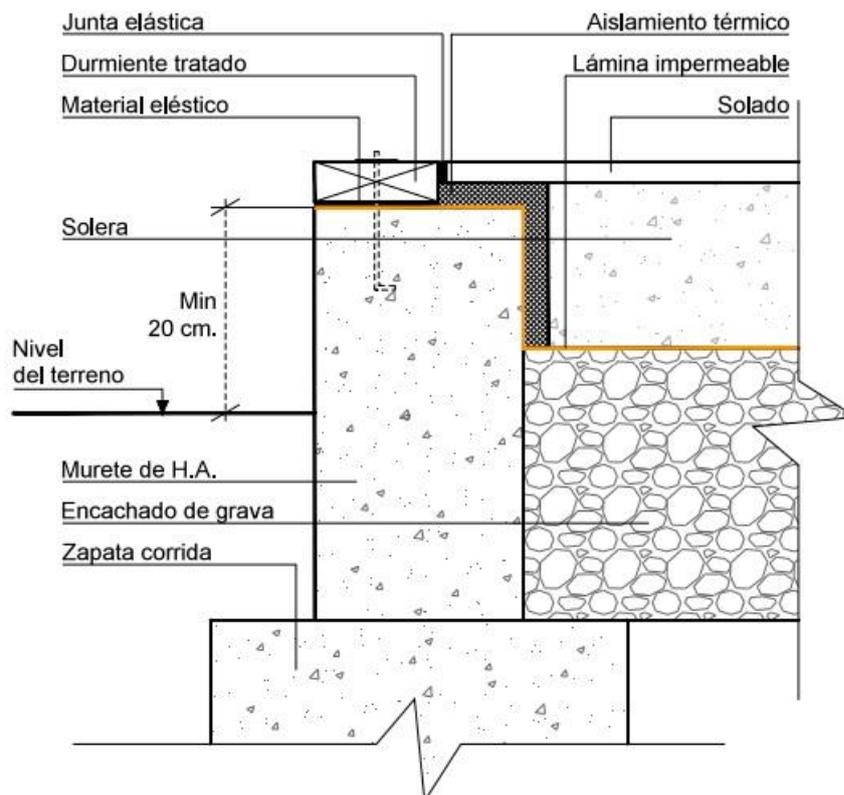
Sección constructiva de primer forjado en contacto en el terreno en el sistema de plataforma de entramado ligero
